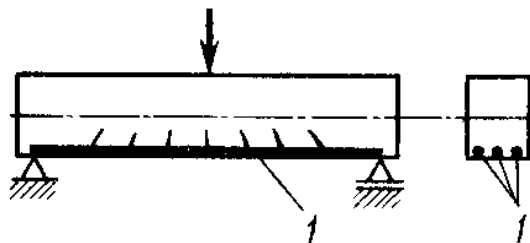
Образование трещин в изгибаемом элементе под нагрузкой: 1– растянутая арматура
